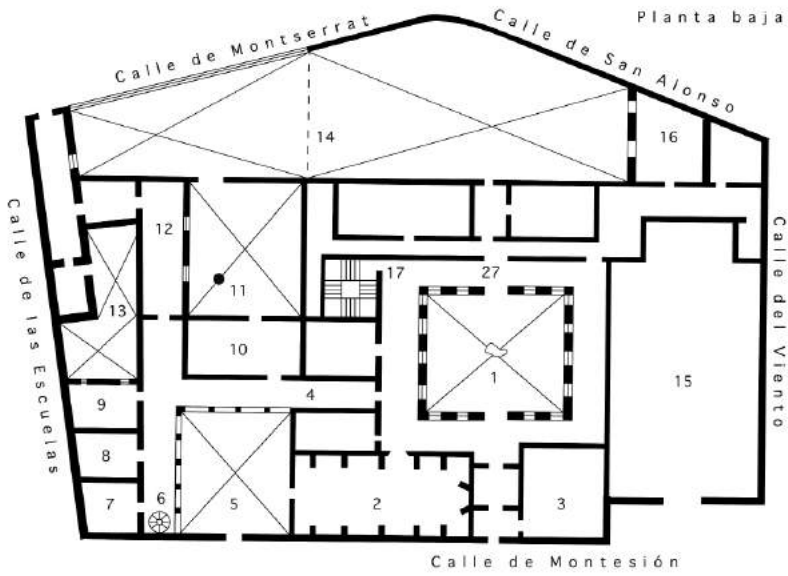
Plano I. Planta baja del edificio de Montesión.
